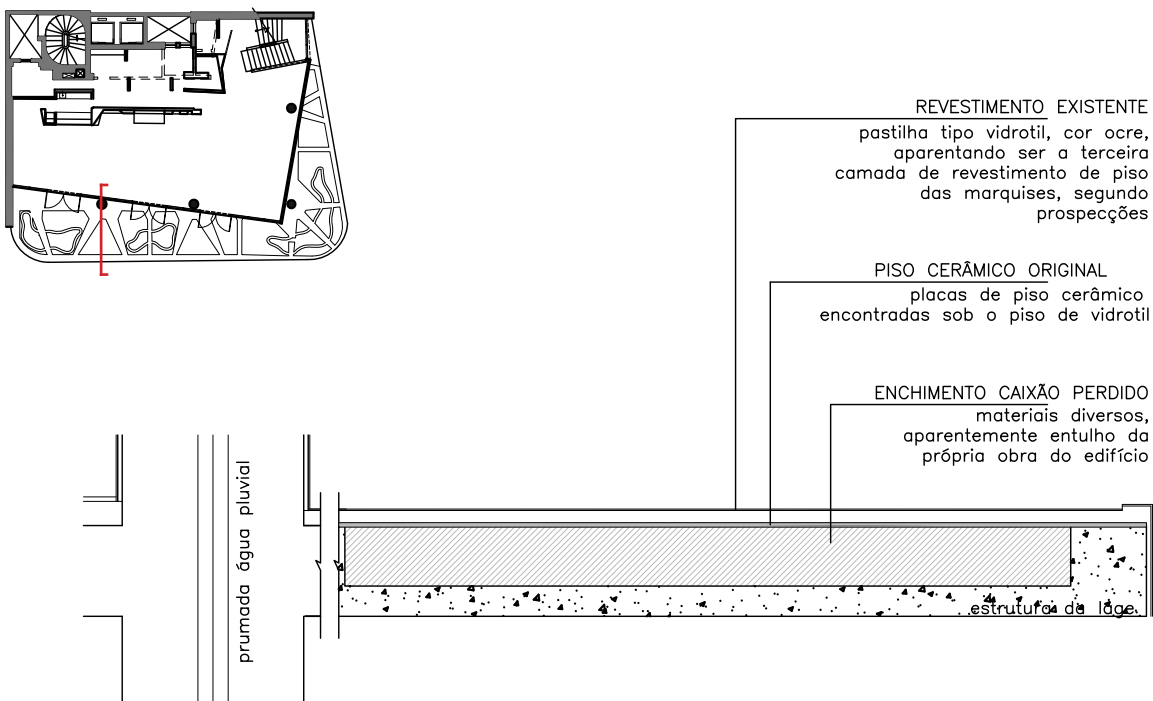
Corte estrutural esquemático | Situação existente - 1:25
